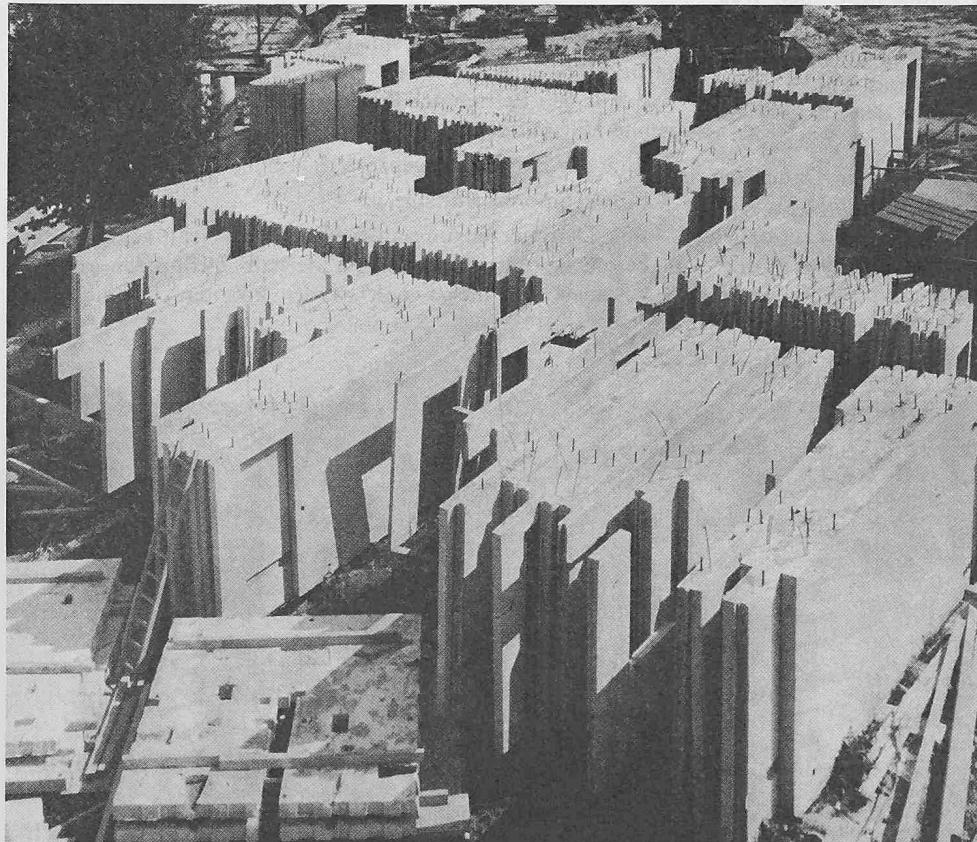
Siedlung Holeeholzacker. Zwischenlager der Bauelemente. Lagerung: Wände senkrecht, Decken horizontal
